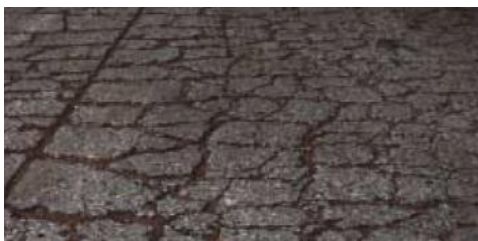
Losas subdivididas- Fuente: Ing. Luis F. Altamirano Kauffmann 2007
